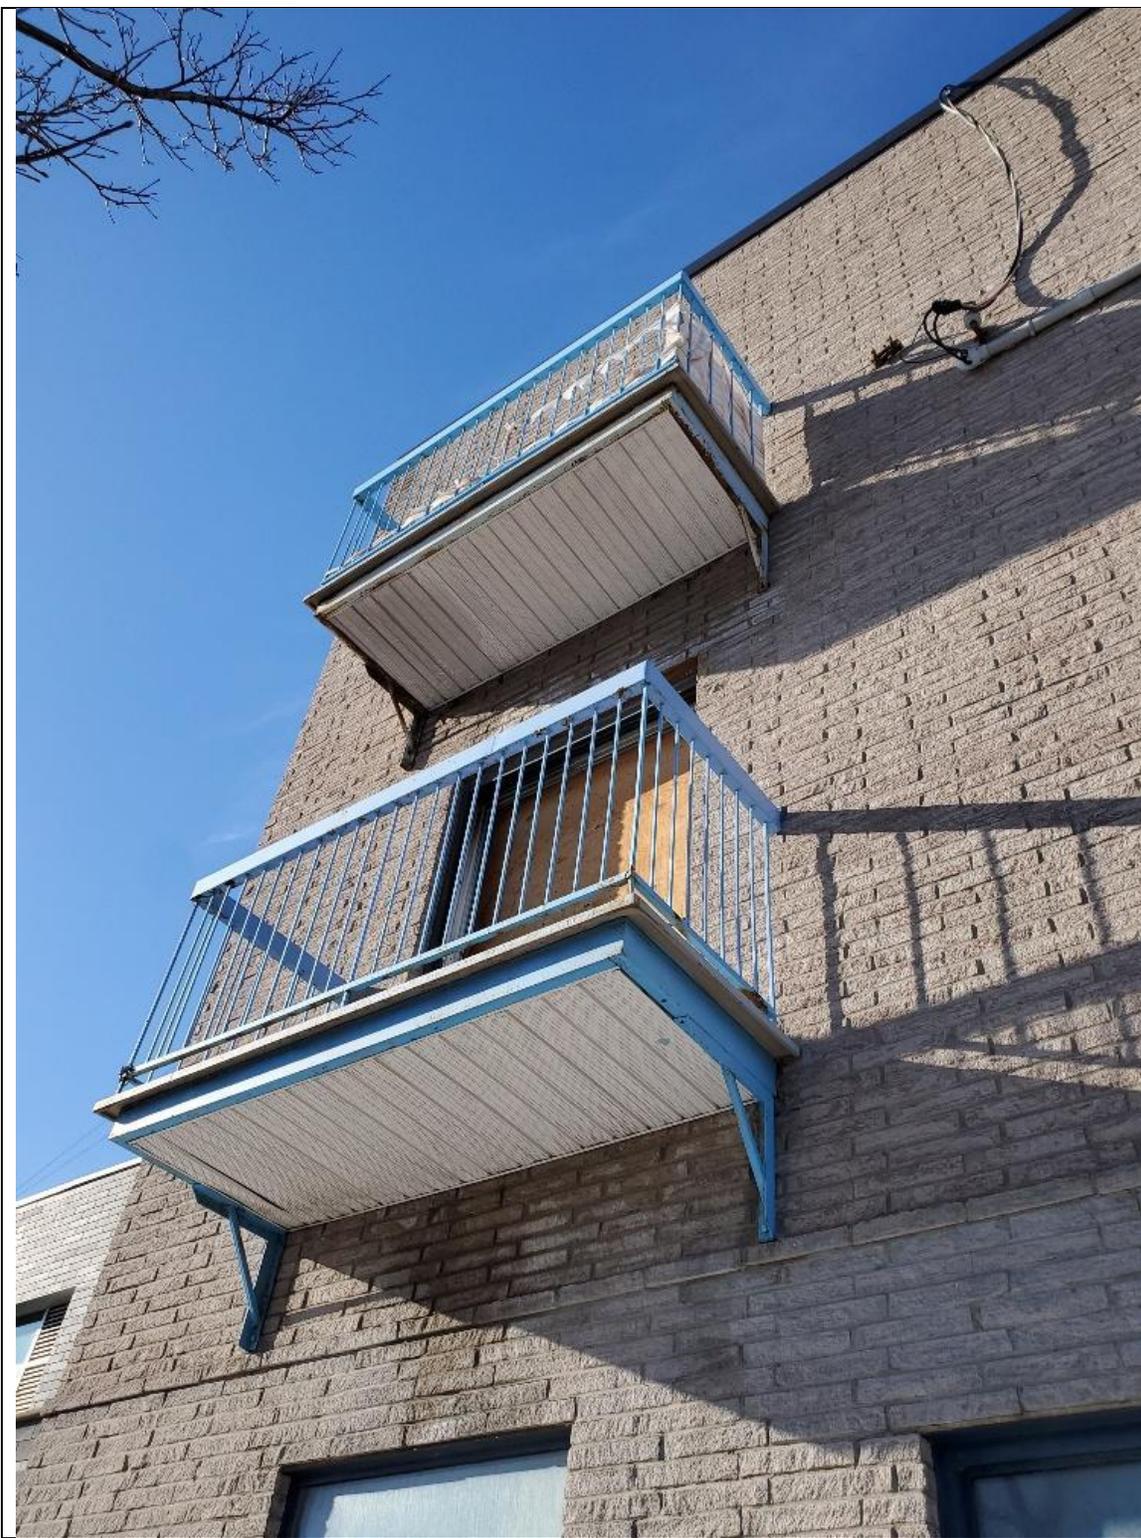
Les balcons sont fixés au travers du parement de maçonnerie dans le carré de bois
